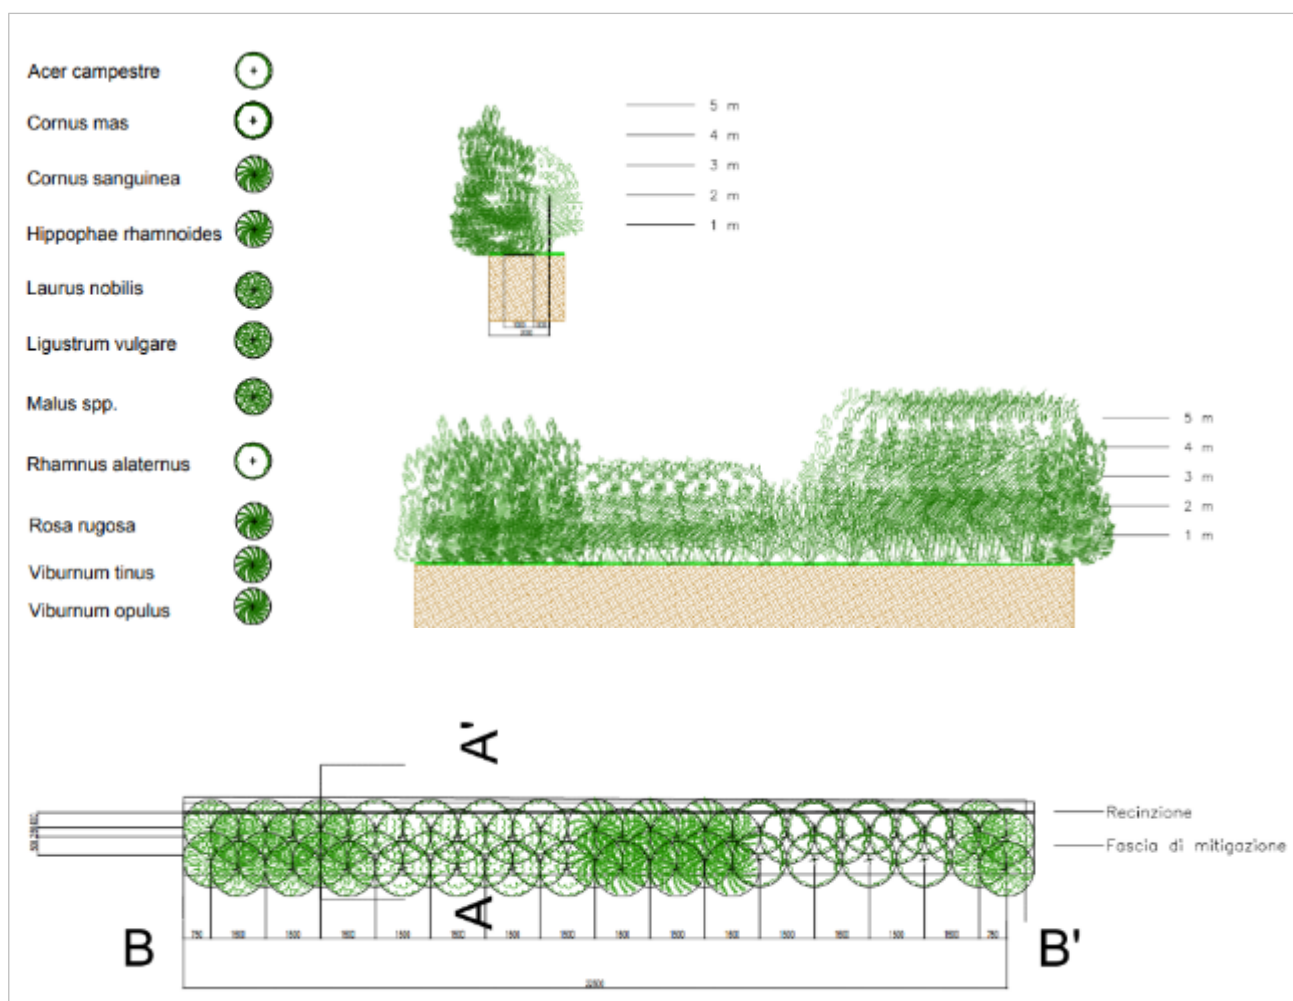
Fascia di mitigazione: selezione botanica, sezioni tipo e modulo d'impianto
